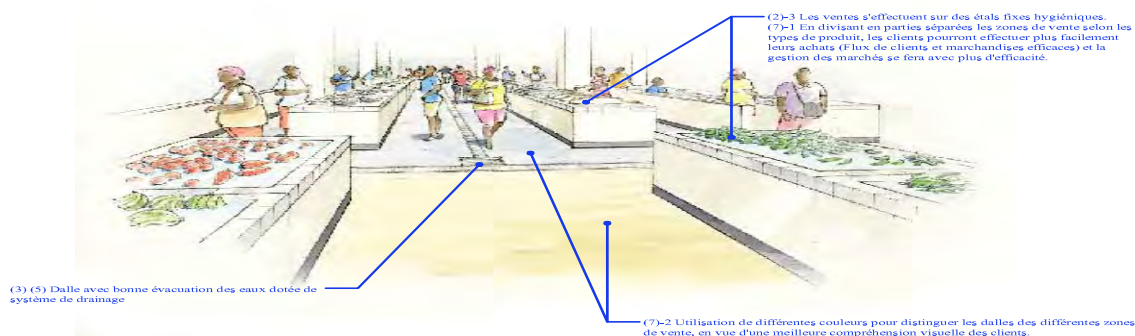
Illustration du plan des installations 3 (marché aux légumes et marchandises générales et marché au détail des poissons frais)
